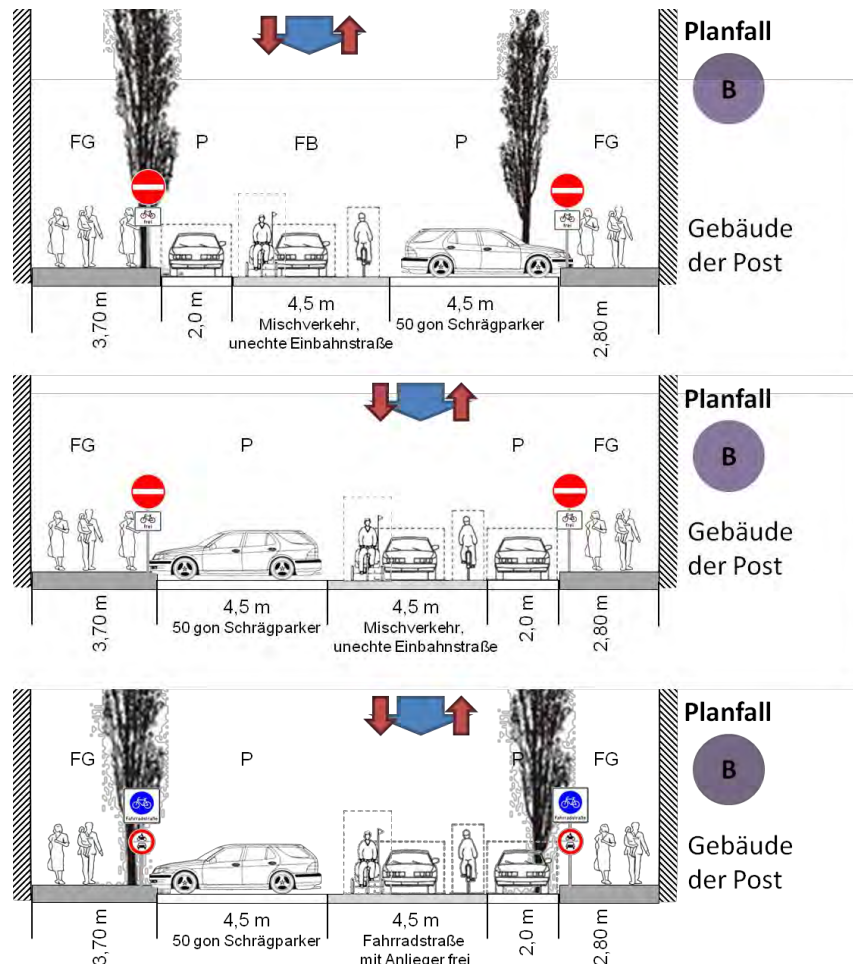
Unechte Einbahnstraße bzw. Fahrradstraße in der Deisenhofener Straße mit Schrägparkern (Planfall B)
